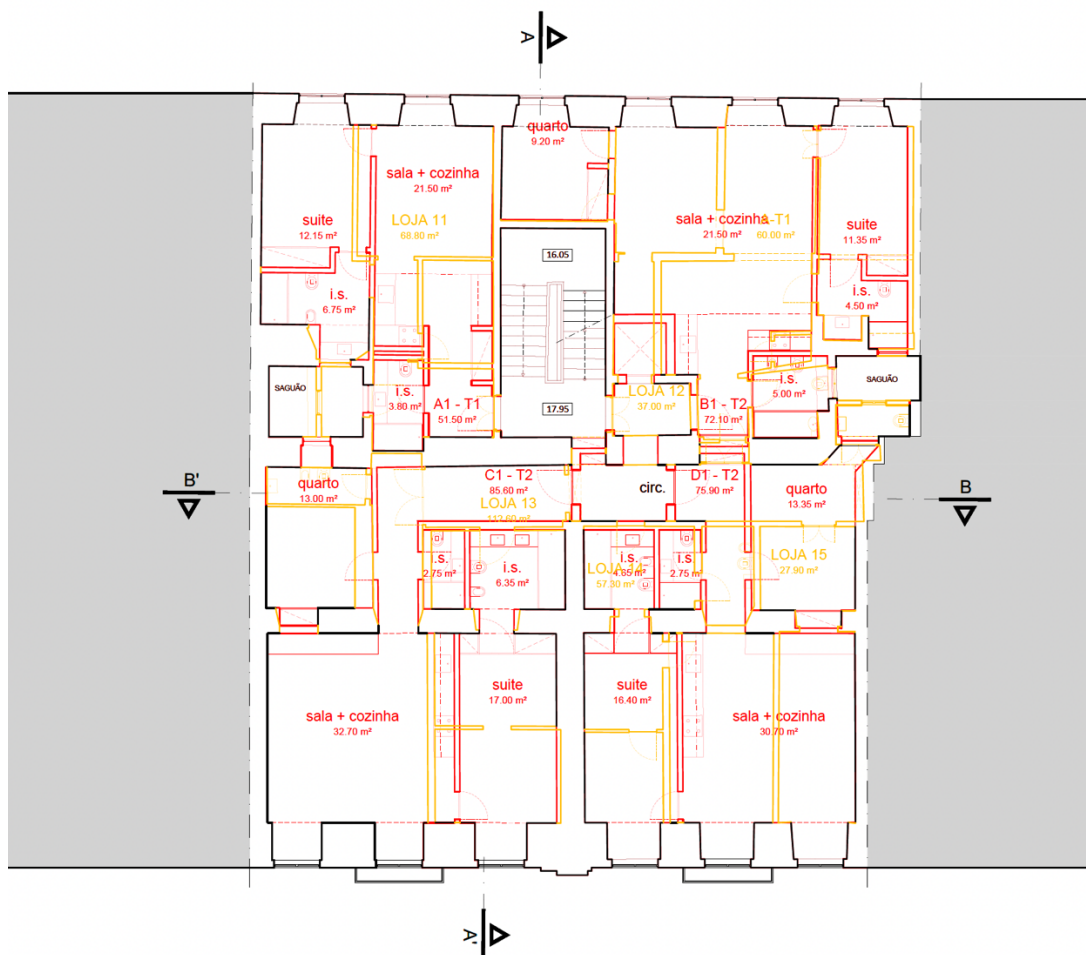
Planta do 2.º andar, mostrando as alterações propostas para reorganização das habitações.
